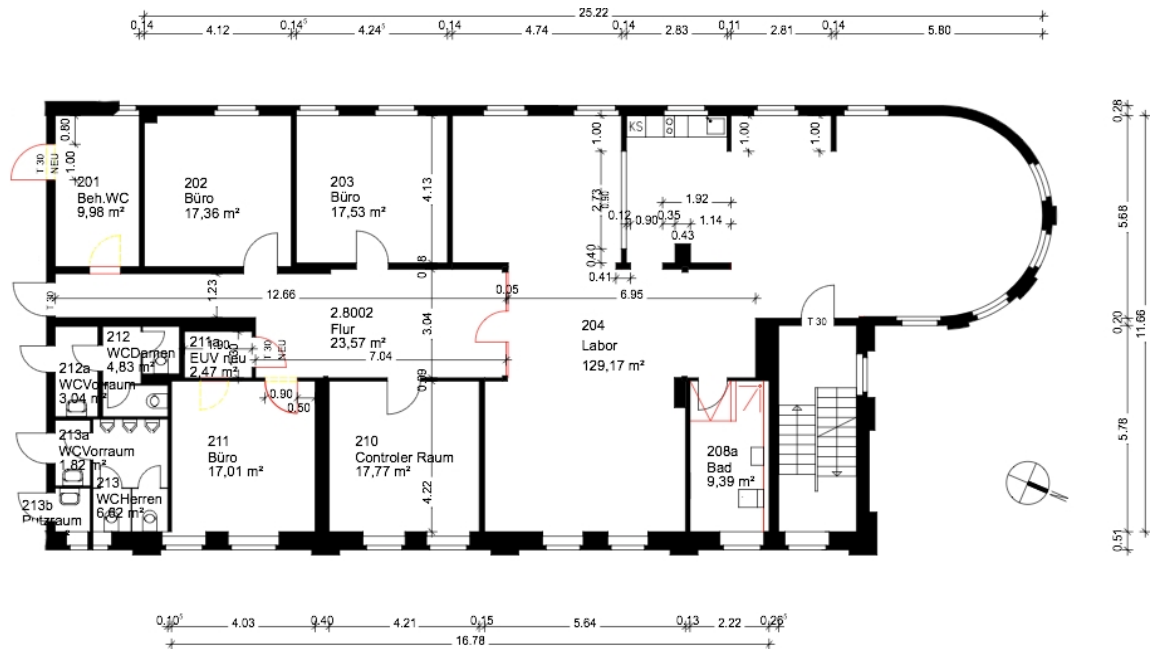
Grundriss des Living Place Hamburg
